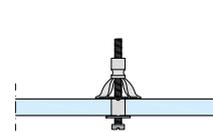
Metallhohlraumdübel Schraube M5 oder M6
